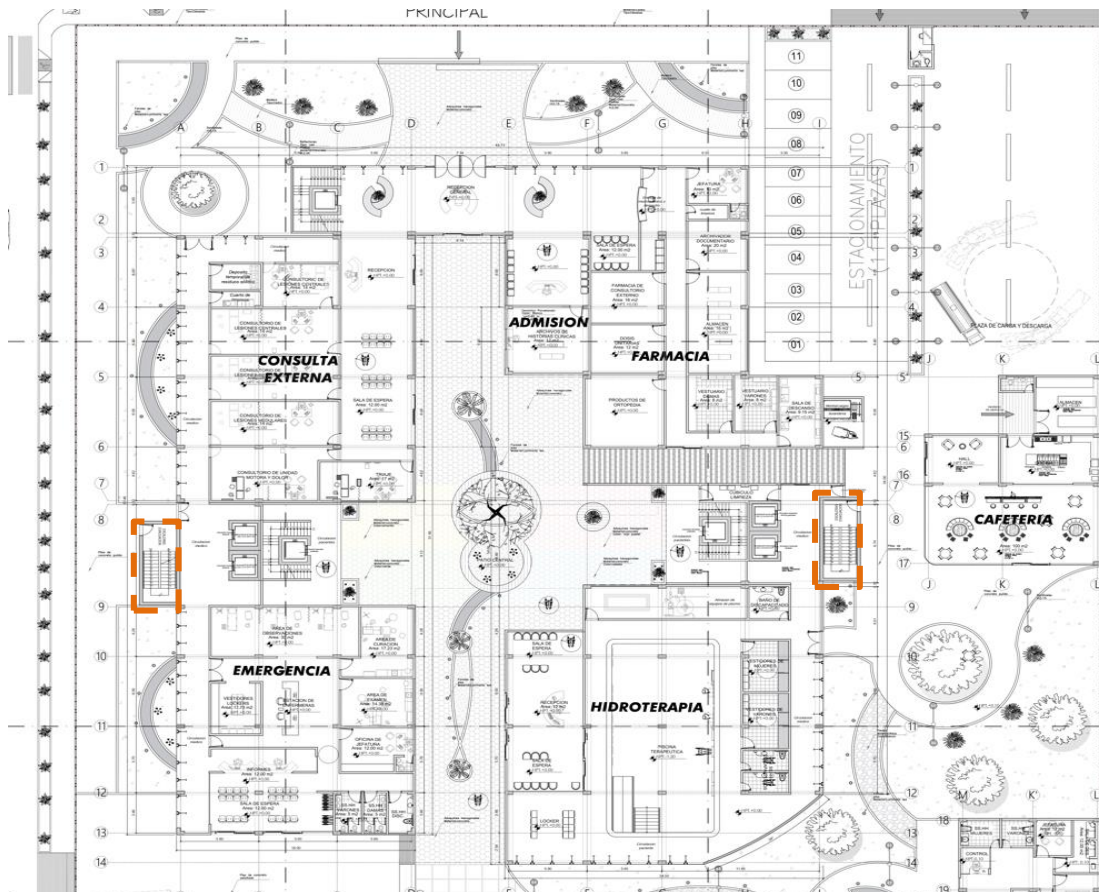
Escalera de evacuación - Planta arquitectónica primer nivel
